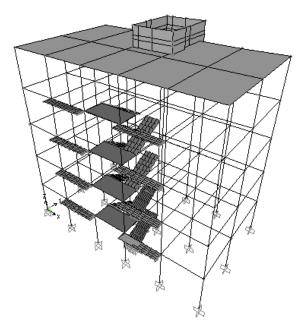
MODELISATION DE LA STRUCTURE AVEC RESERVOIR (POSITION3)
